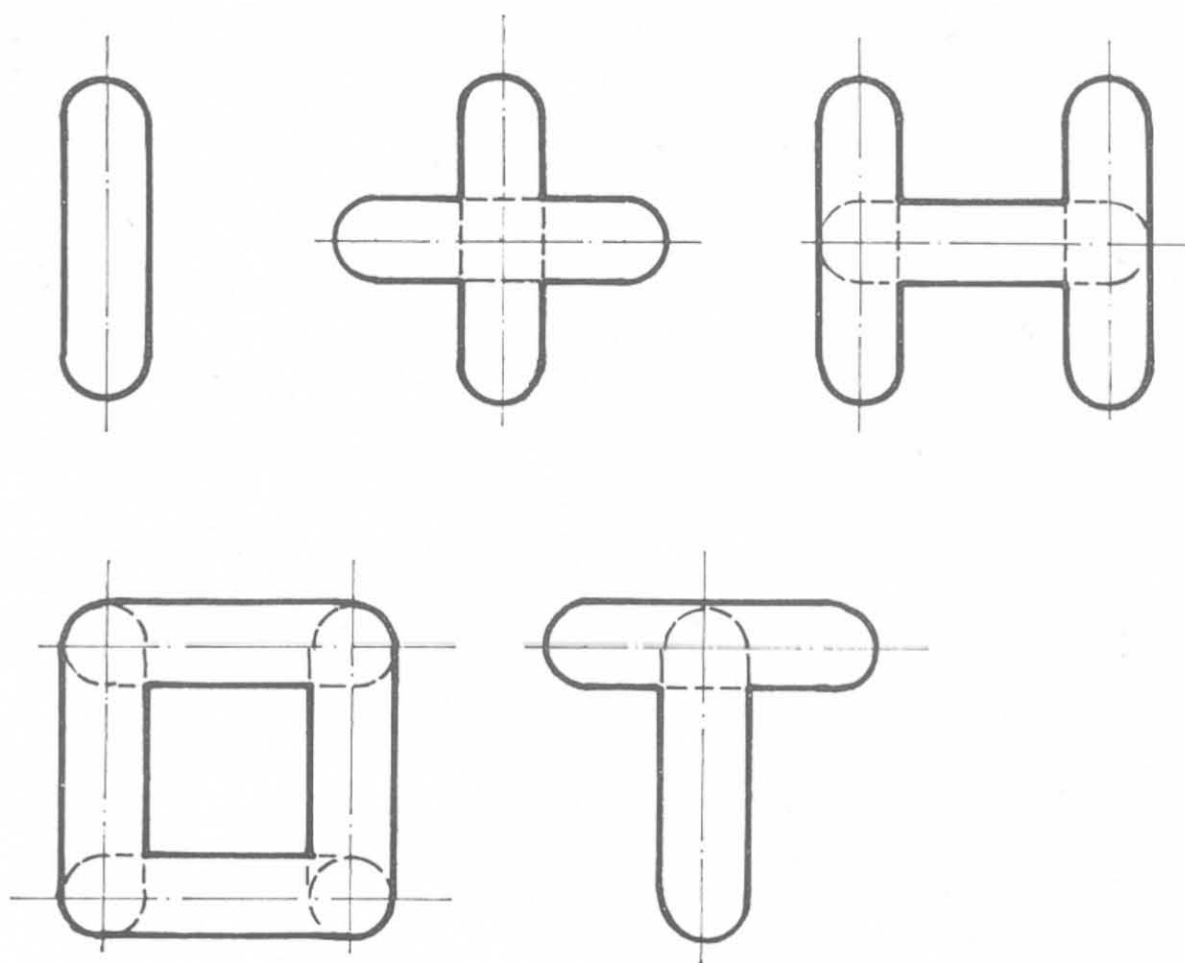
Elementi di diaframma come strutture di fondazione.
